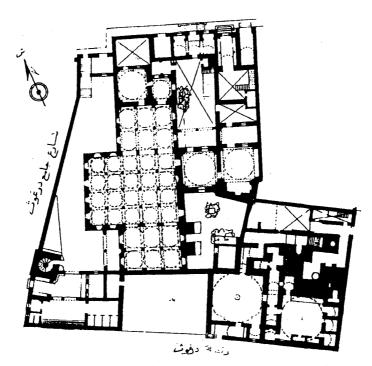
مسقط أفقي لجامع الخروبة بطرابلس الغرب في ليبيا. (عن موسوعة الآثار الاسلامية في ليبيا - ج١).
